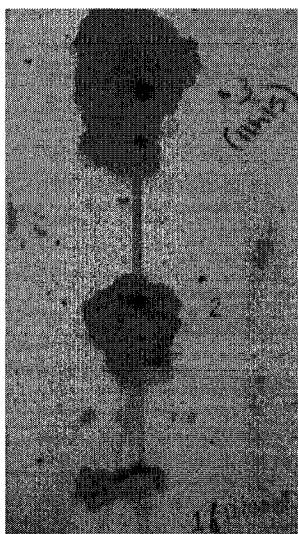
Photo des cônes d'arrachement des ancrages cimentaires de 60 mm de profondeur
